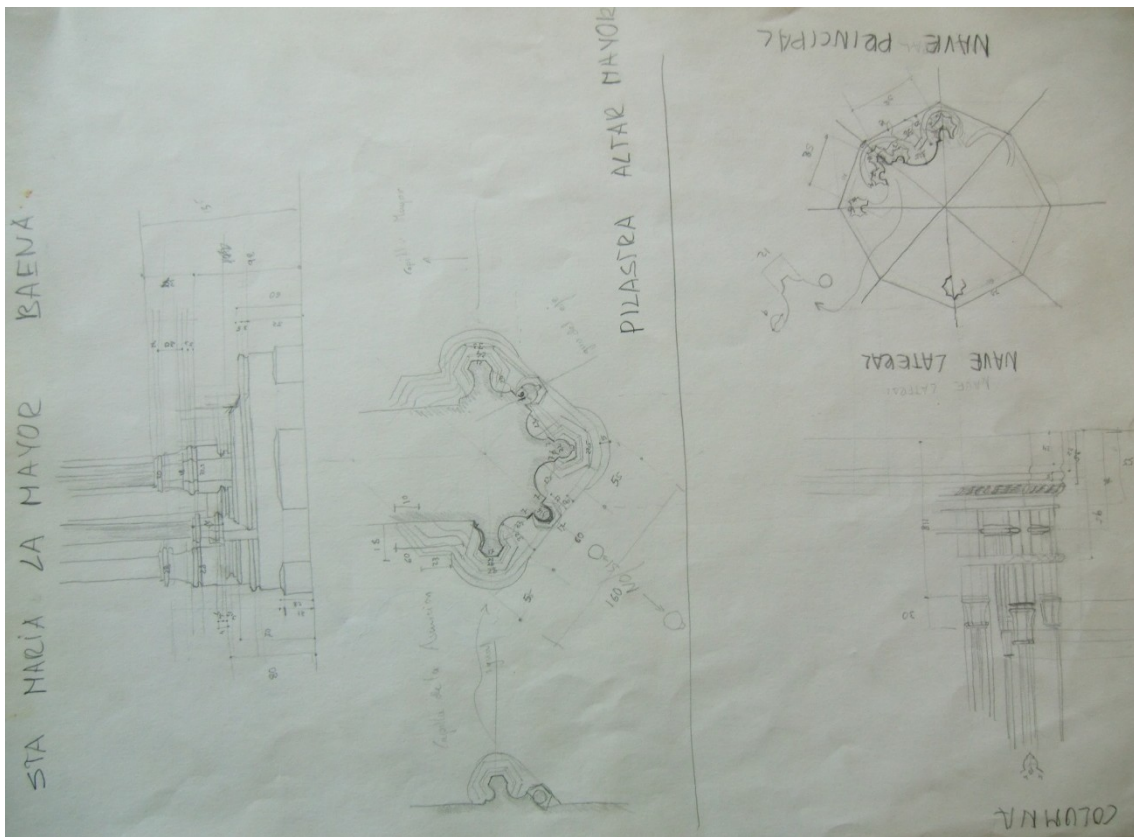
Elementos ornamentales columnas naves - Croquis del levantamiento realizado por el autor
